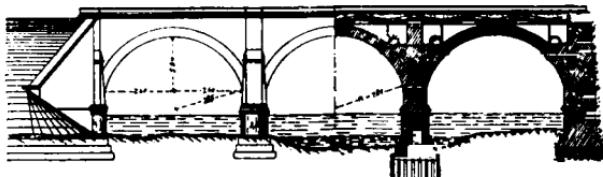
Фасадъ и разрѣзъ устоя съ откосными крыльями.
